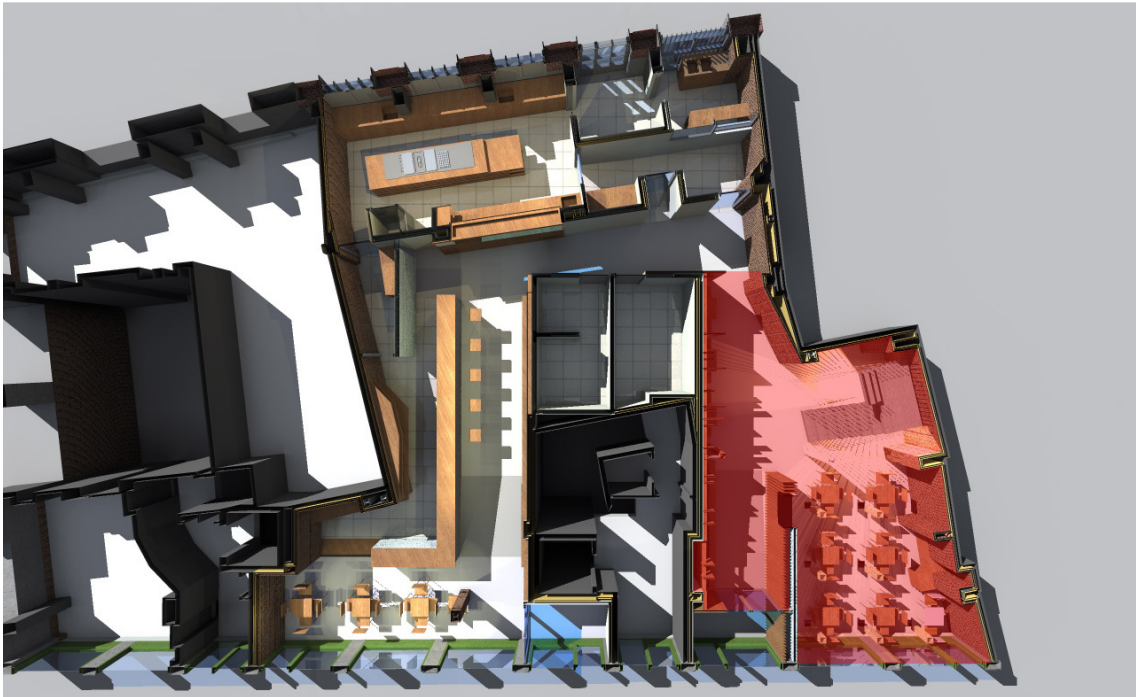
8_ Tiempo de reverberación: Zona de restaurante en planta baja
